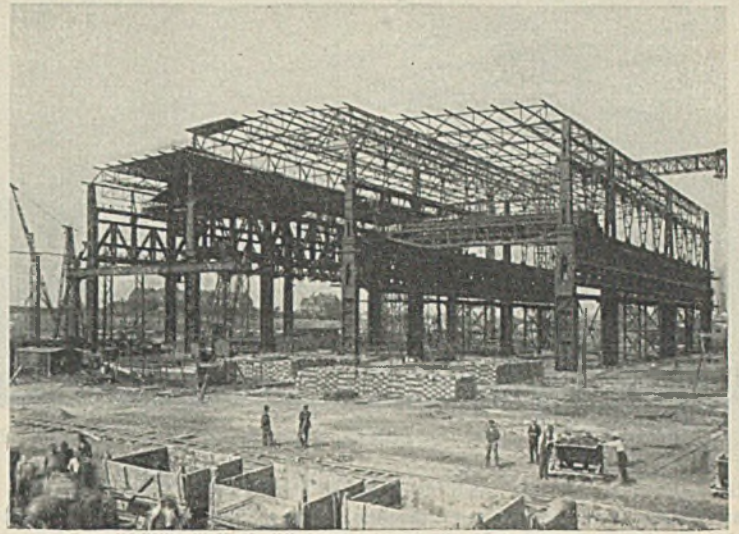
Stahltragwerk des Martinstahlwerkes mit fertig aufgestelltem Unterbau.
